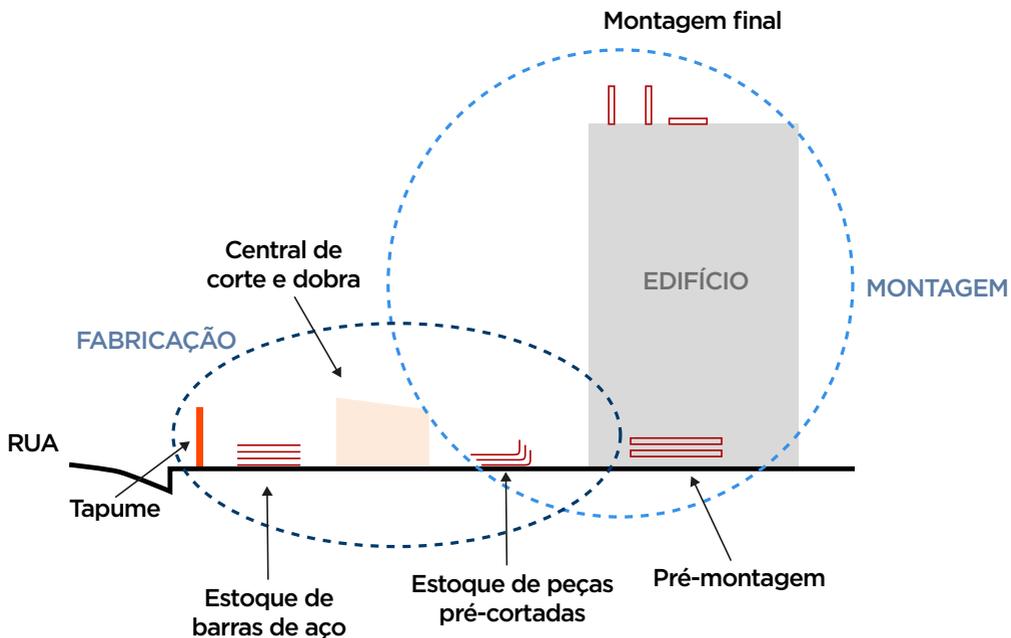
Ilustração das subetapas da fabricação e montagem de armação.
